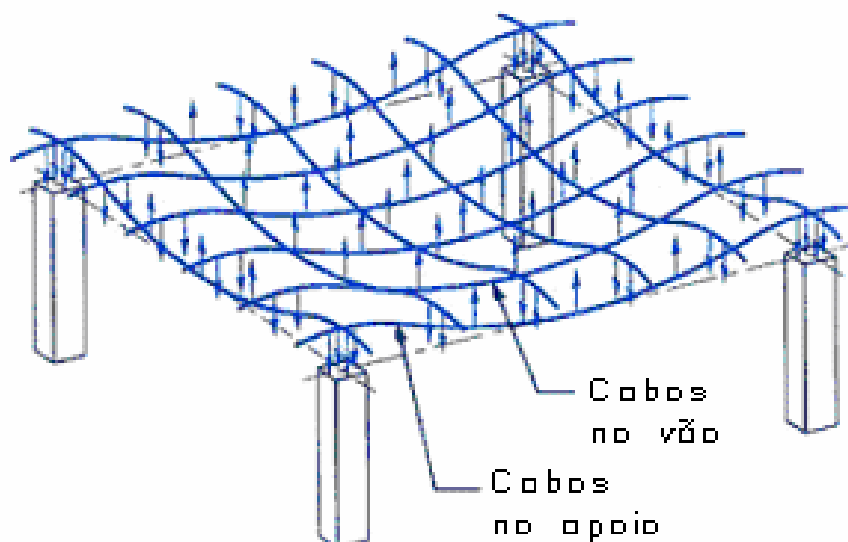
Carregamento Vertical Atuante no Concreto para Cabos Uniformemente Distribuídos
